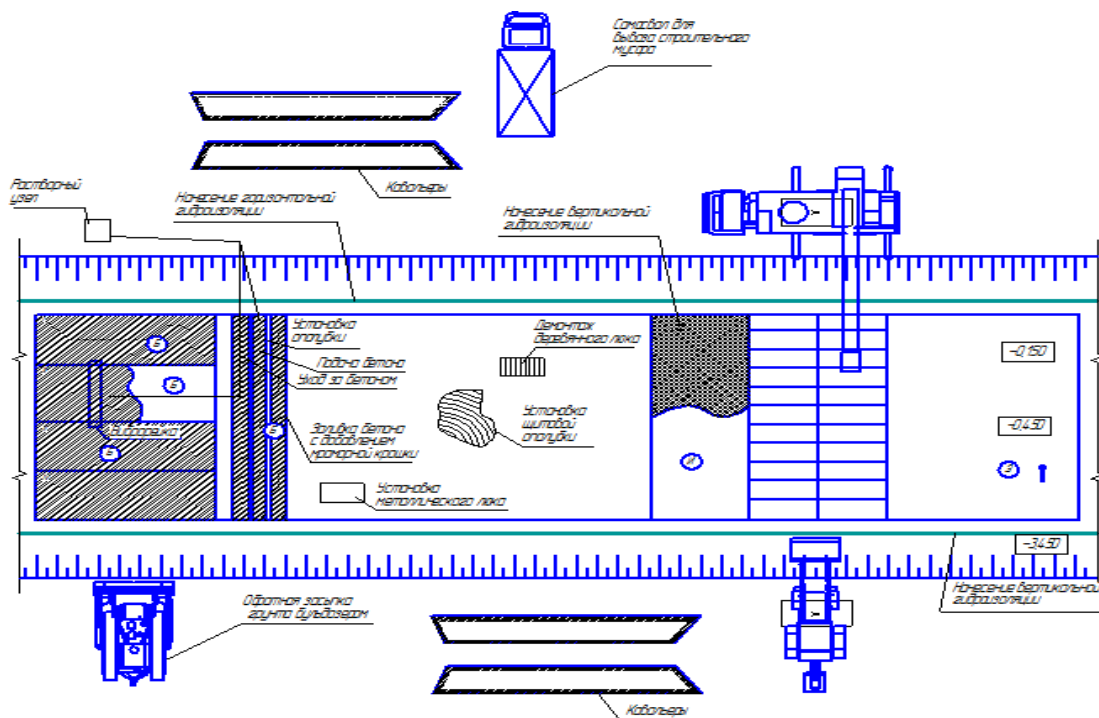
Схема организации работ при устройстве гидроизоляции перехода
